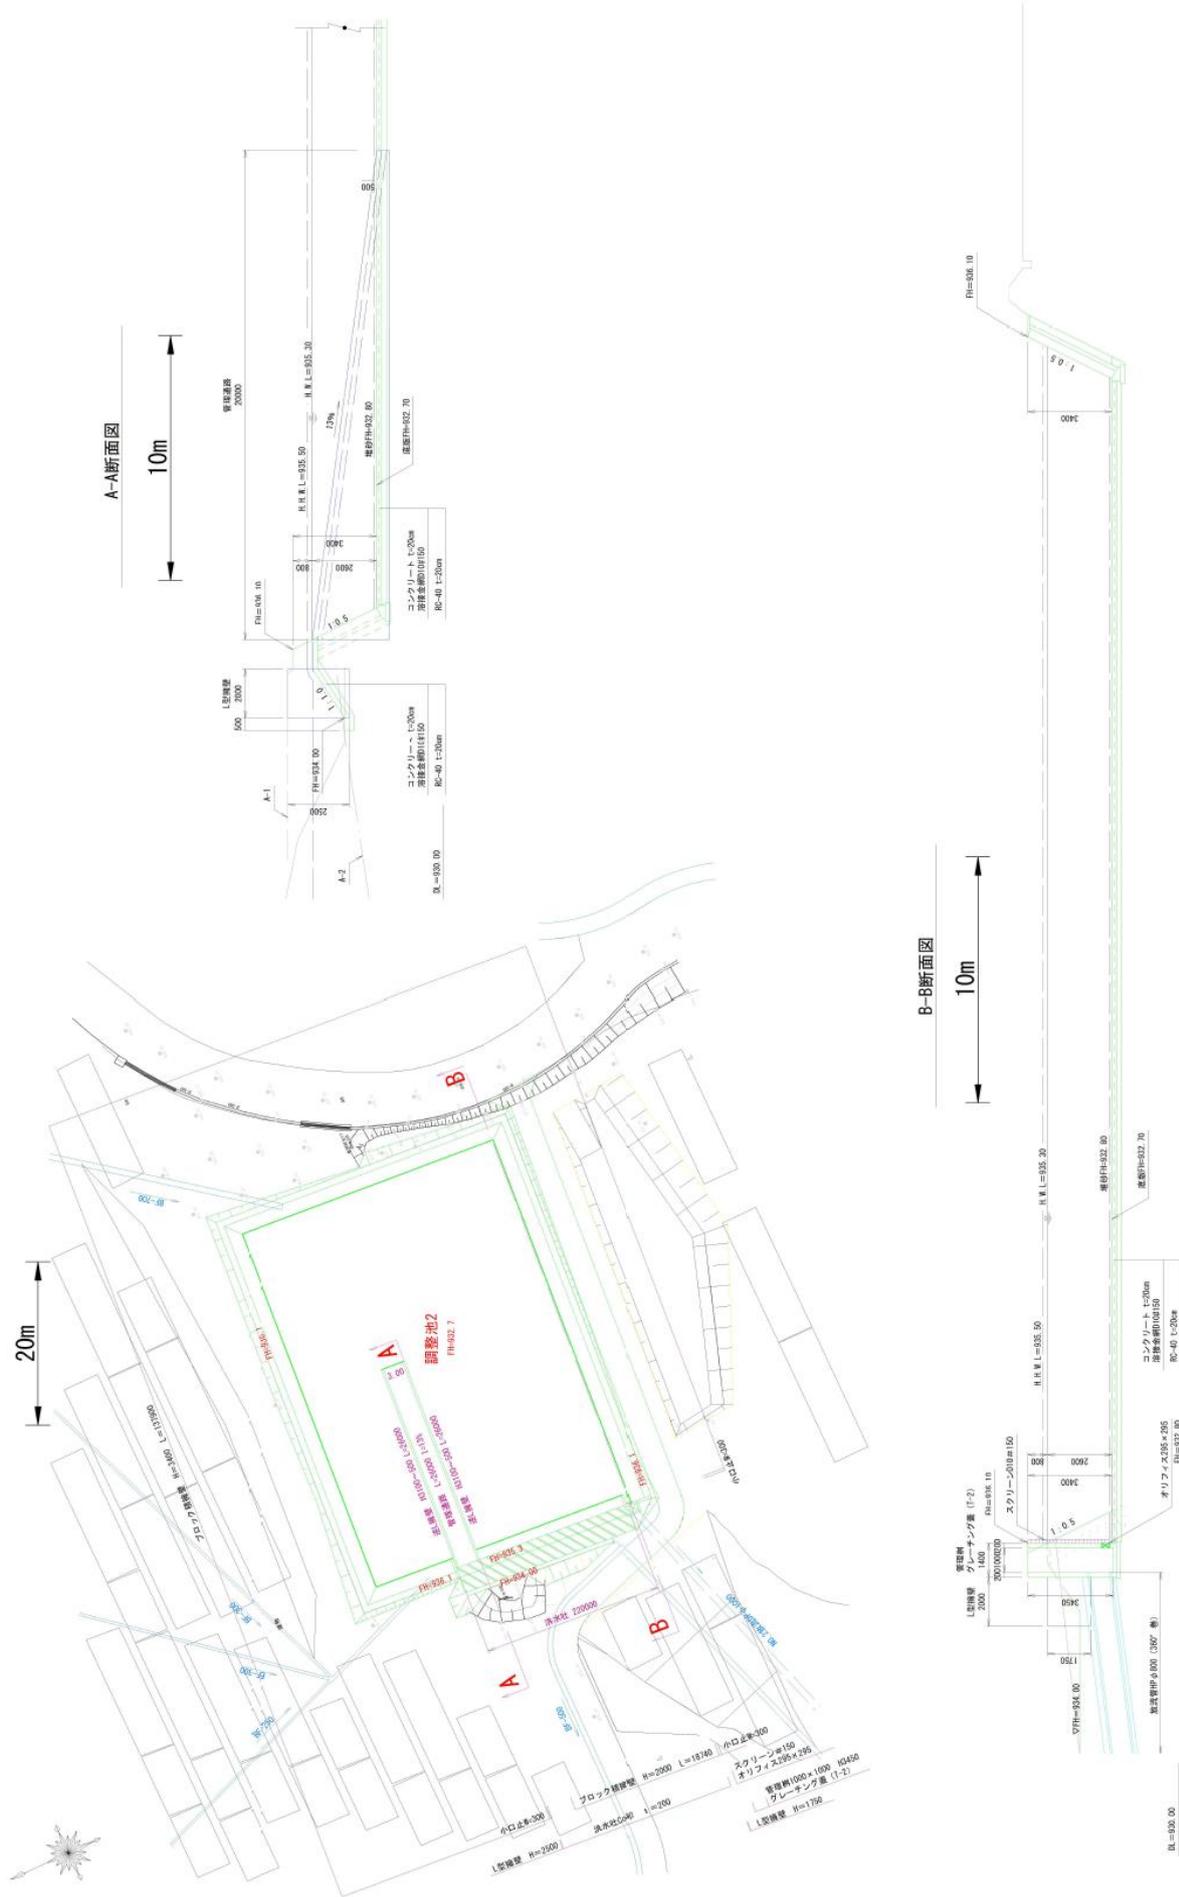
(3) No.2調整池計画図(平面図、断面図)
